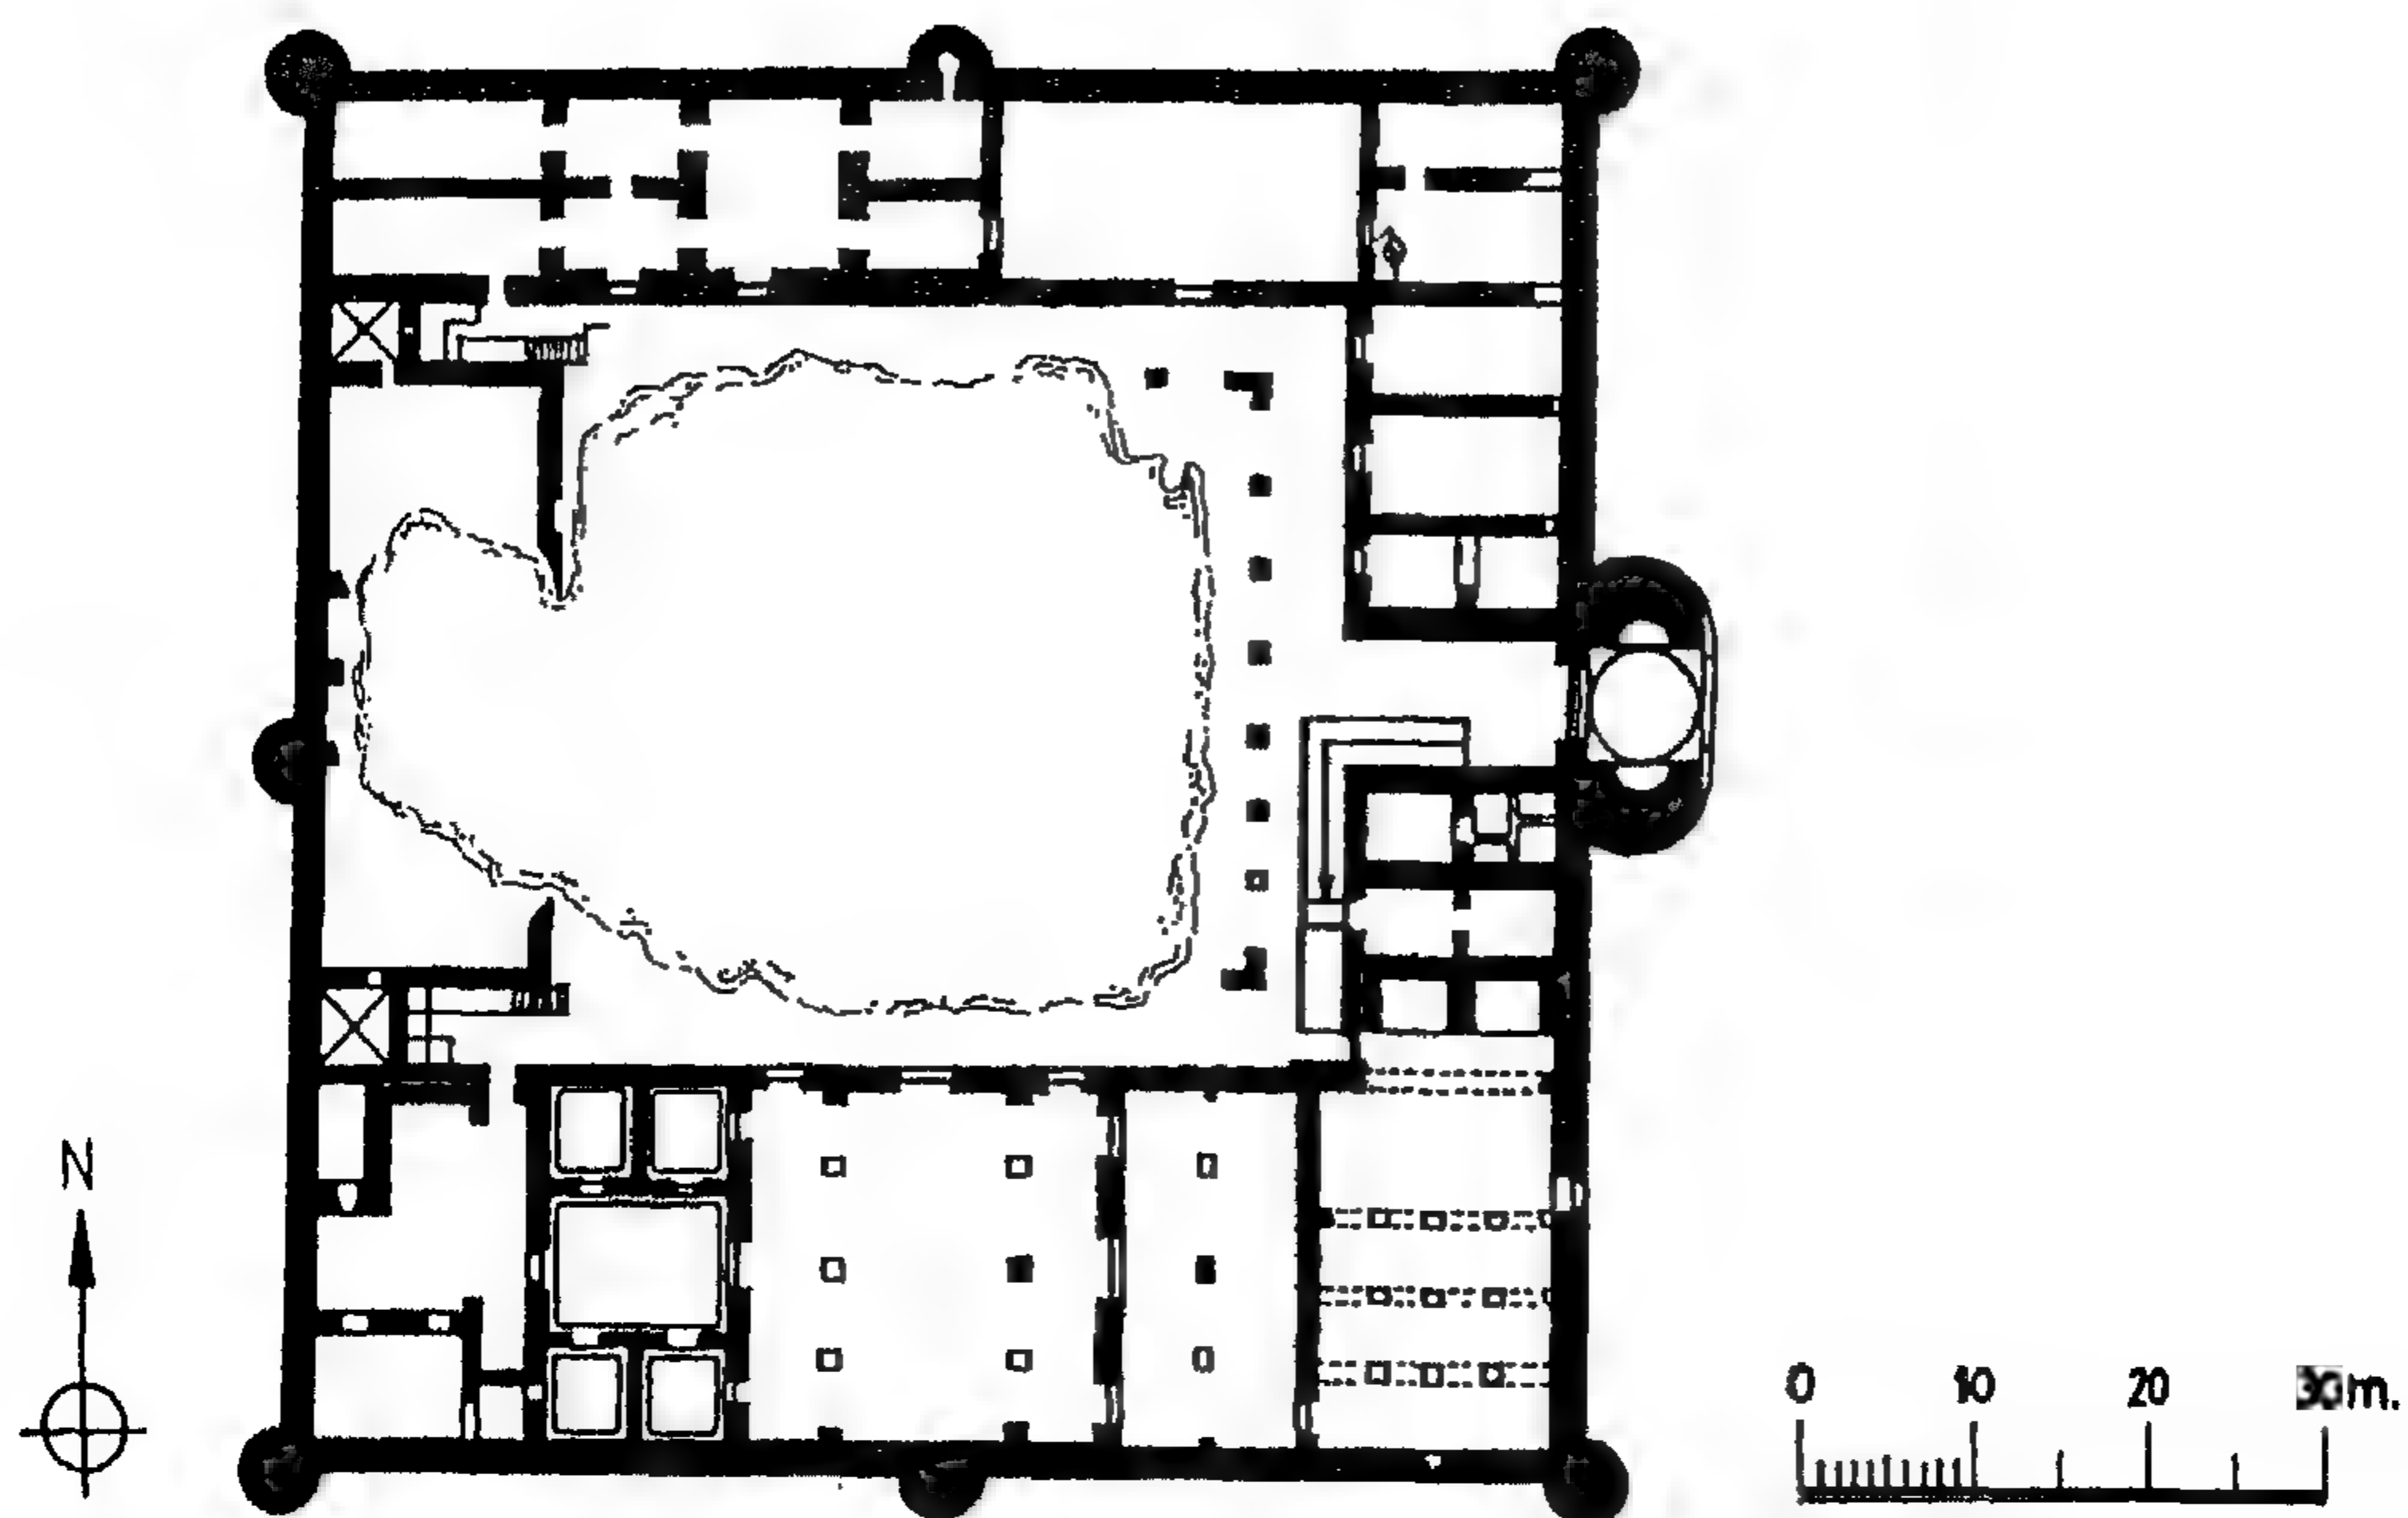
مسقط أفقي للبيمارستان القيمري في دمشق (عن: الريحاني).
